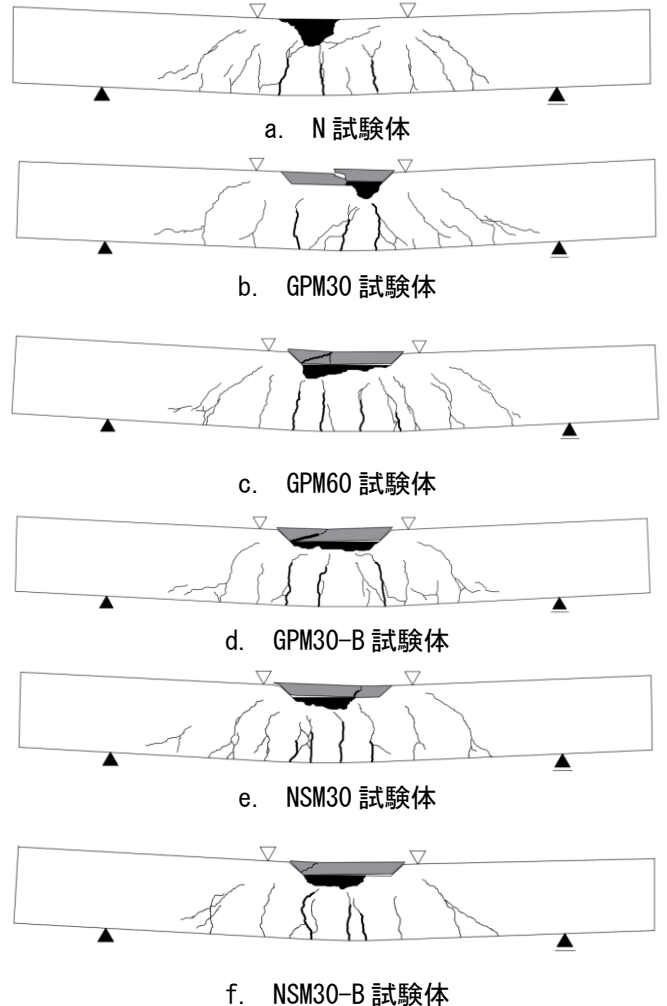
ひび割れおよび破壊状況 (曲げ試験終了時)
